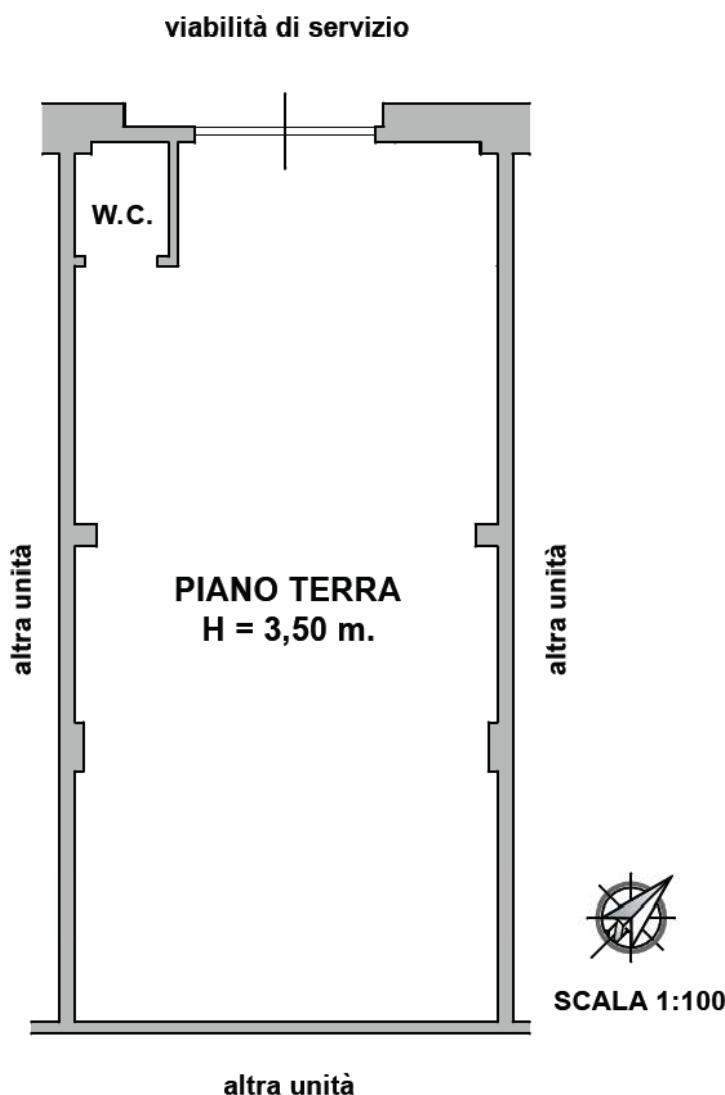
LOTTO 4 - Planimetria laboratorio artigianale foglio 76 - part. 620 - sub. 34
